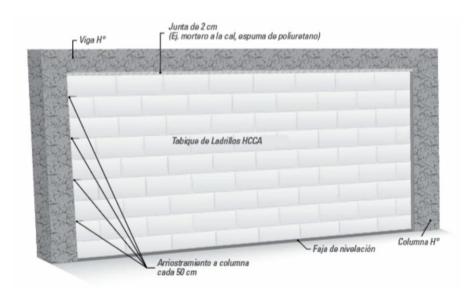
Vinculo de mampostería de hormigón celular y estructura de H°A°. Fuente: Manual constructivo de ladrillo de marca reconocida.
